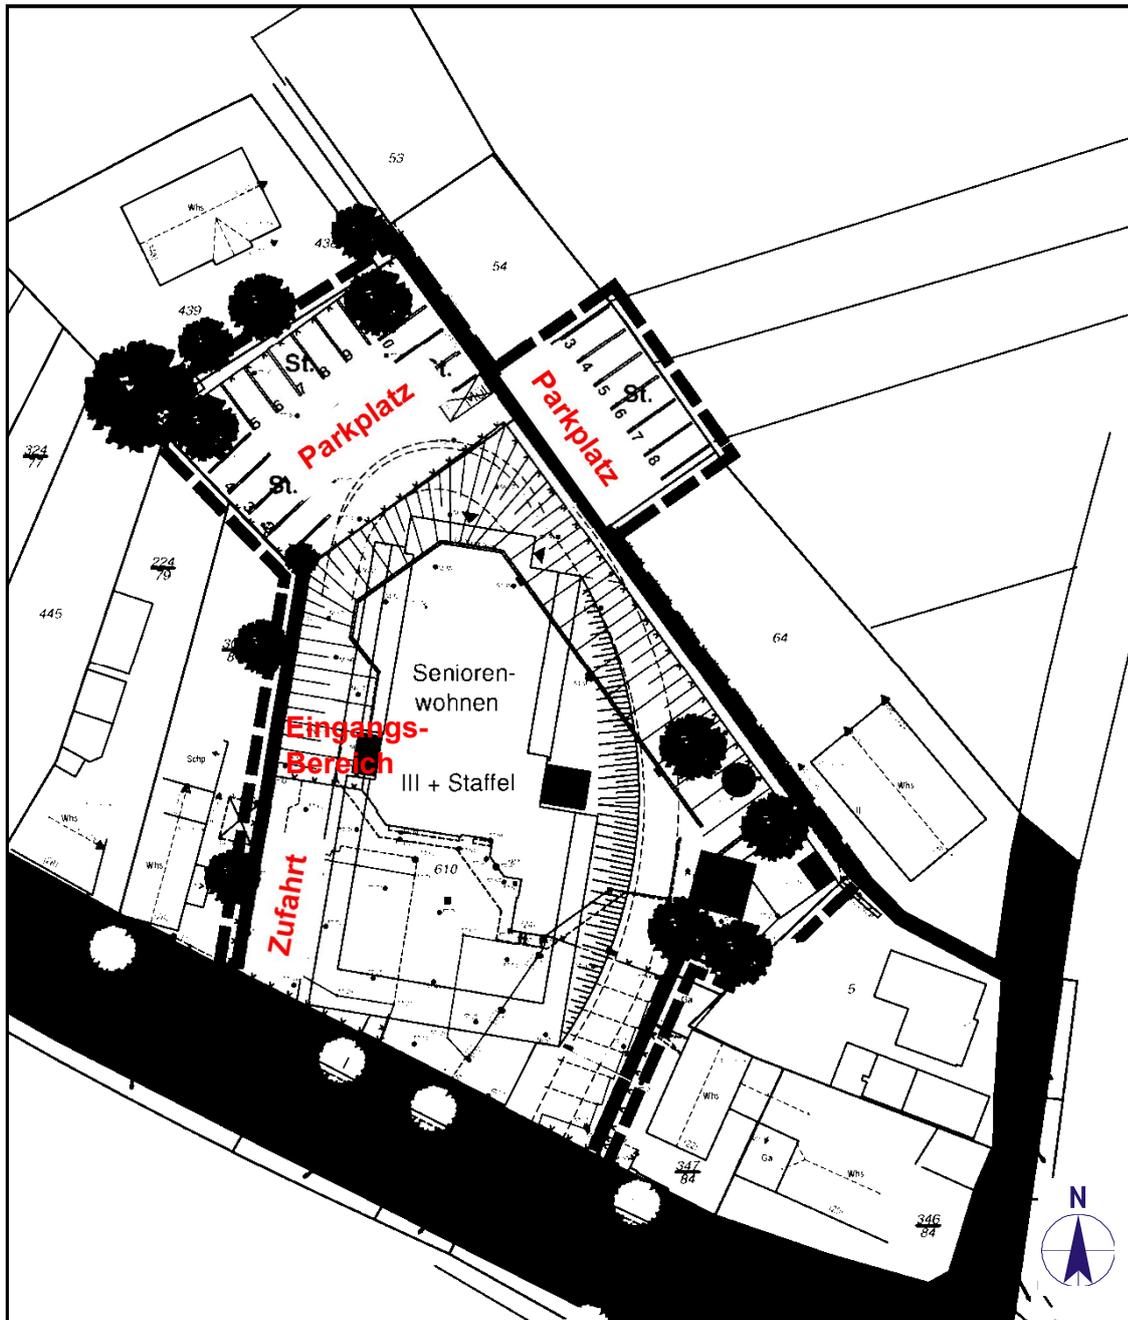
Lageplan des geplanten Seniorenstifts mit Zufahrts-, Eingangs- und Parkbereichen, unmaßstäblich
